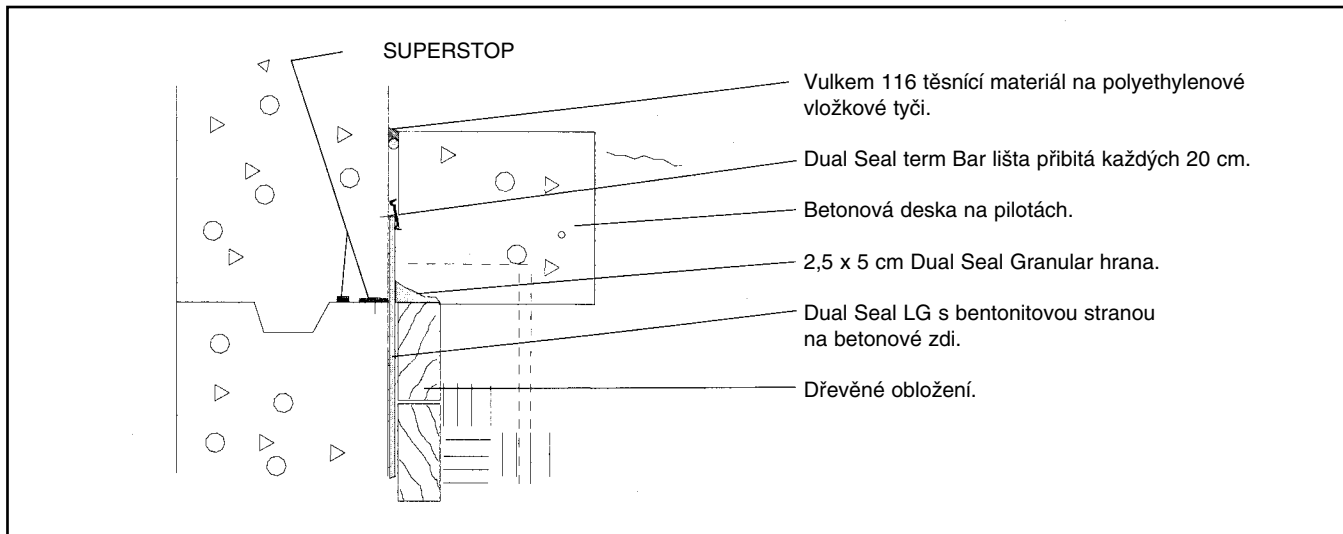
Instalace Dual Seal LG do průniku zdi.
